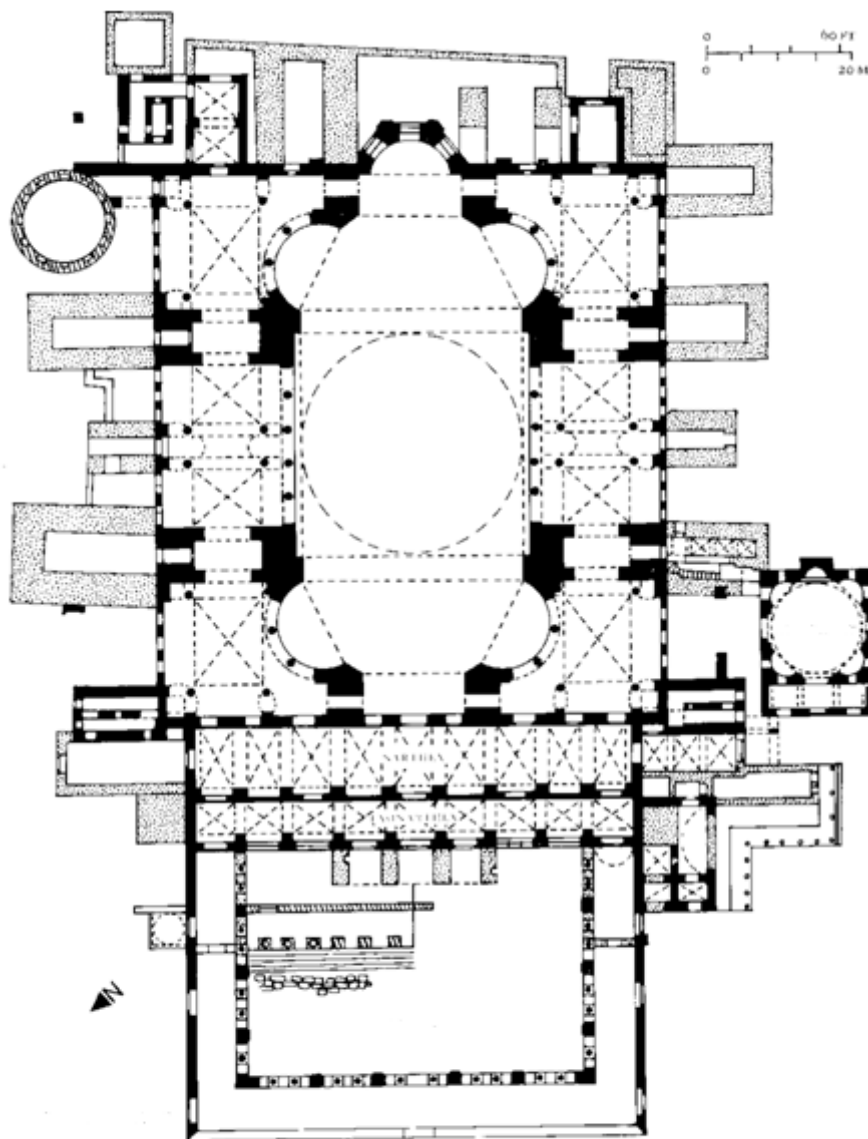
Planta baixa da Catedral de Santa Sofia de Constantinopla.
